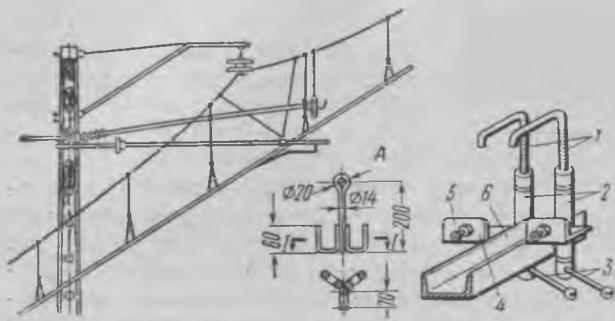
Общий вид расположения нового фиксатора на поддерживающем крюке и в направляющем приспособлении:
